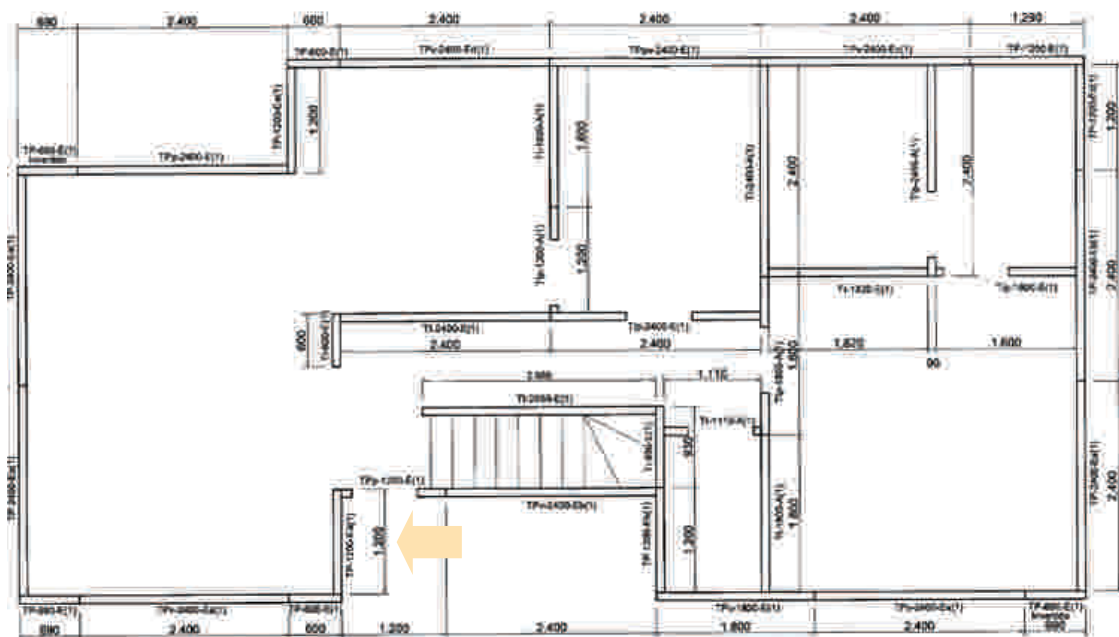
64: Plano planta de arquitectura del primer piso con distribución de recintos.
